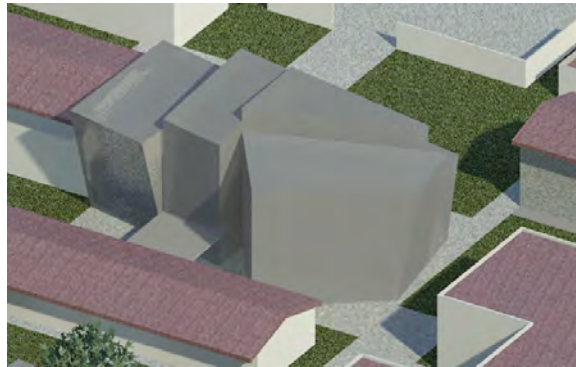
y 160. Modificaciones y perspectiva del sexto elemento del segundo edificio.
